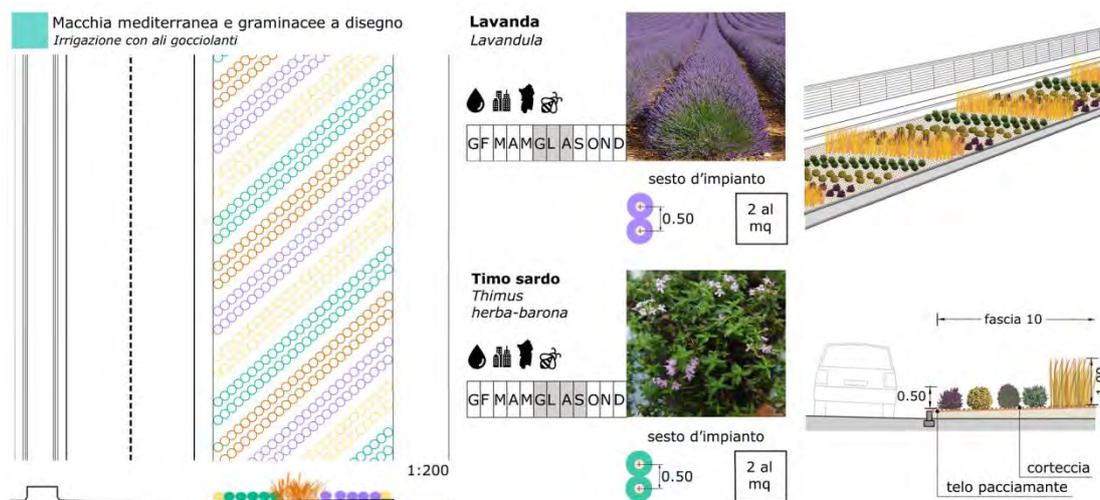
Stralcio progettuale planimetria sistemazione a verde
